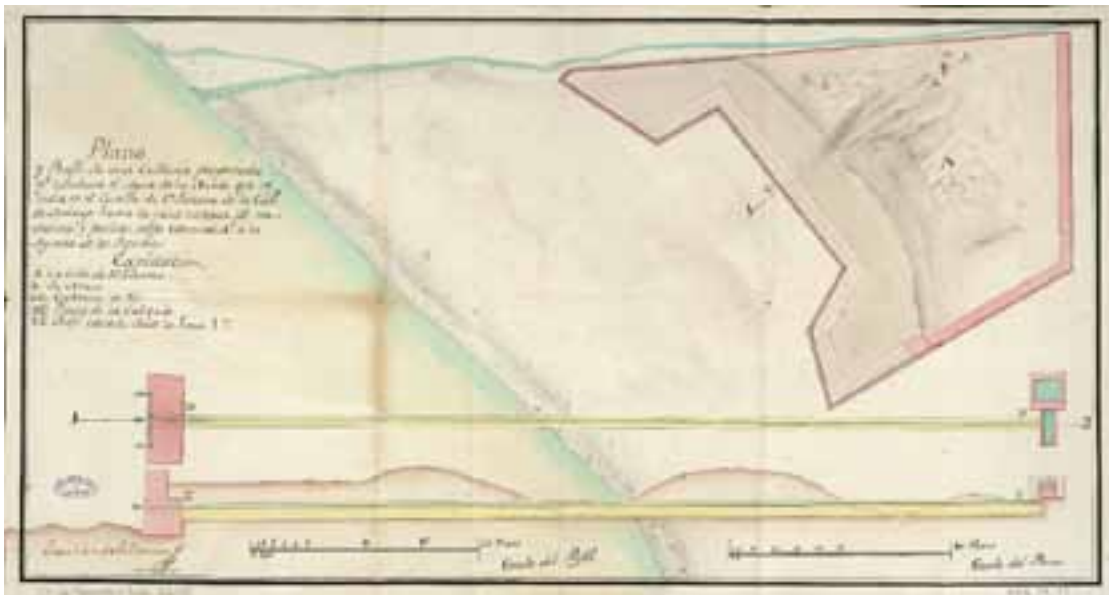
Planta y alzado de la cañería proyectada por Joaquín de Villanova (1783), Ministerio de ECD. Archivo General de Simancas, MPD, Sig. 59-61.
